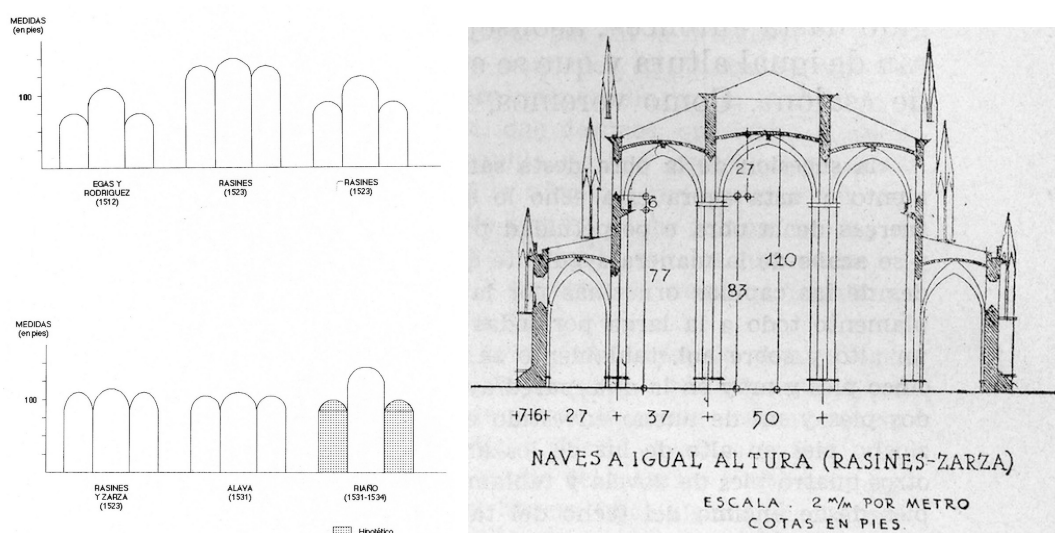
Diversas propuestas de alzado de naves escalonadas y tipo *halle* para la Catedral de Salamanca (1512-1534) (A. Castro, 1992)
